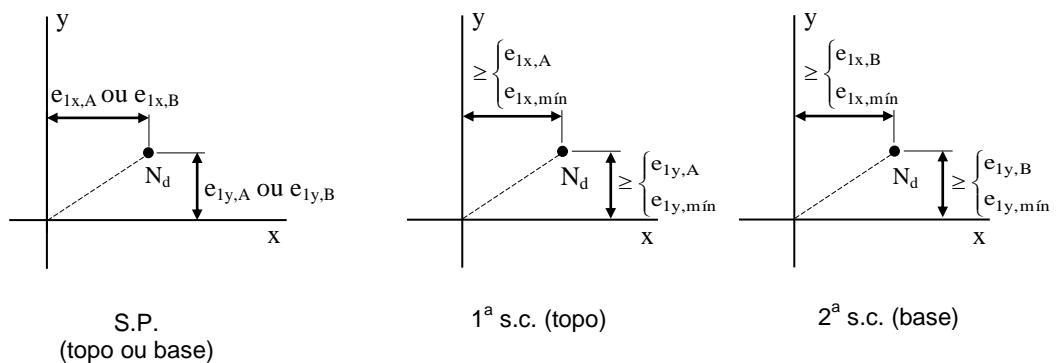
Situação de projeto e de cálculo para a seção de extremidade (topo e base) do pilar de canto.
